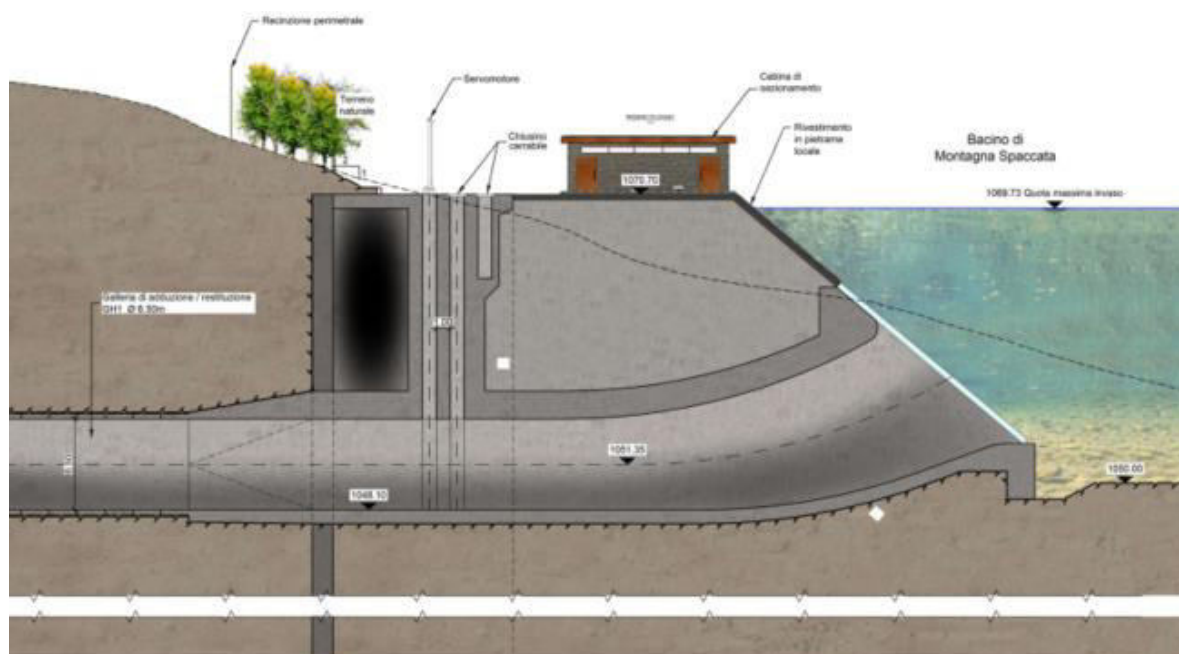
Sezione dell'opera di presa del bacino di Montagna Spaccata
